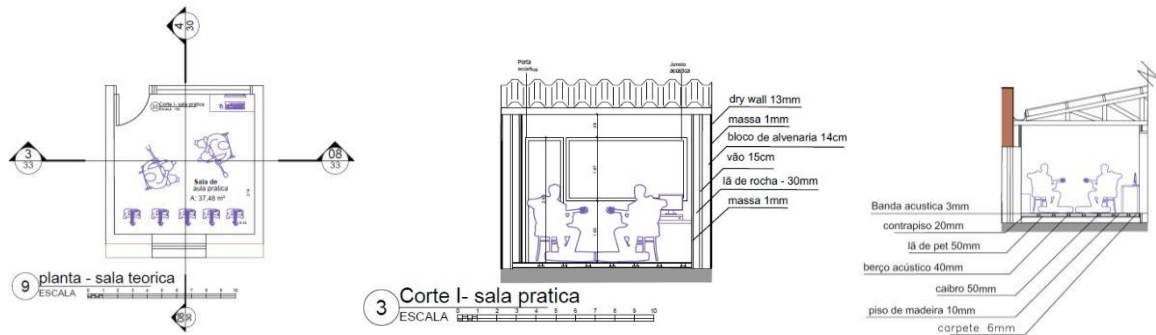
Planta e corte detalhado da sala de pratica instrumental
